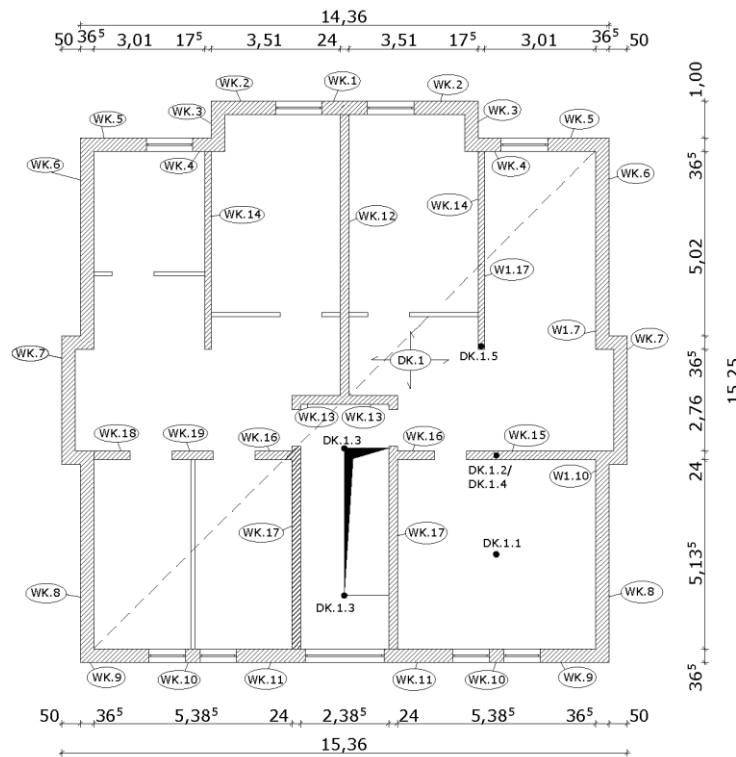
Grundriss des Kellergeschosses nach [2]
